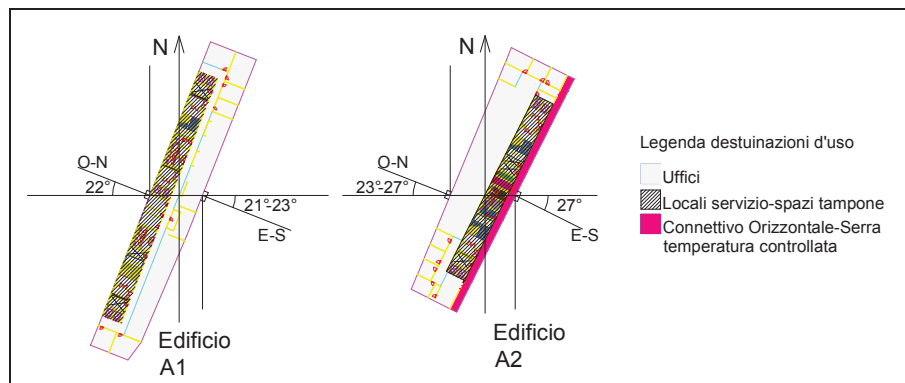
Caso di studio – Orientamento prospetti e schema distributivo.
